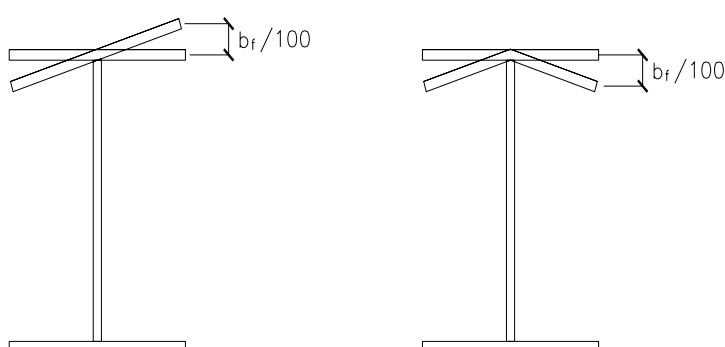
Tolerância de fabricação de perfis I soldados segundo a AWS
